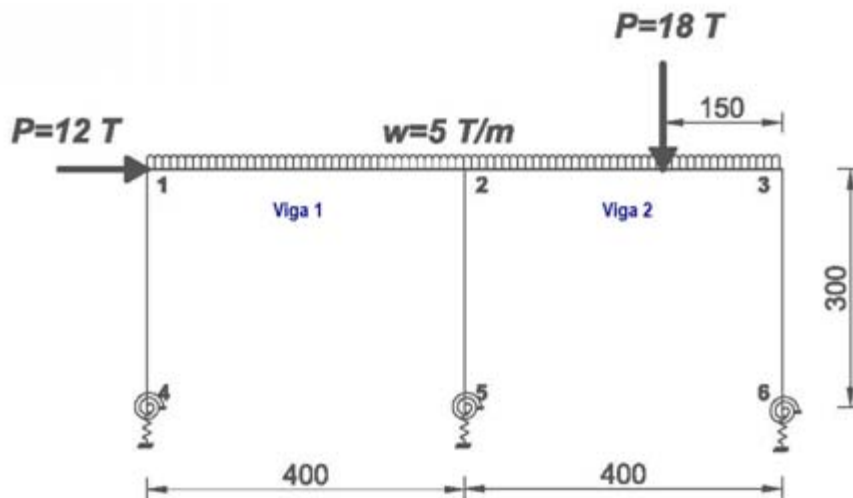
Marco Plano con apoyos elásticos tipo Winkler
